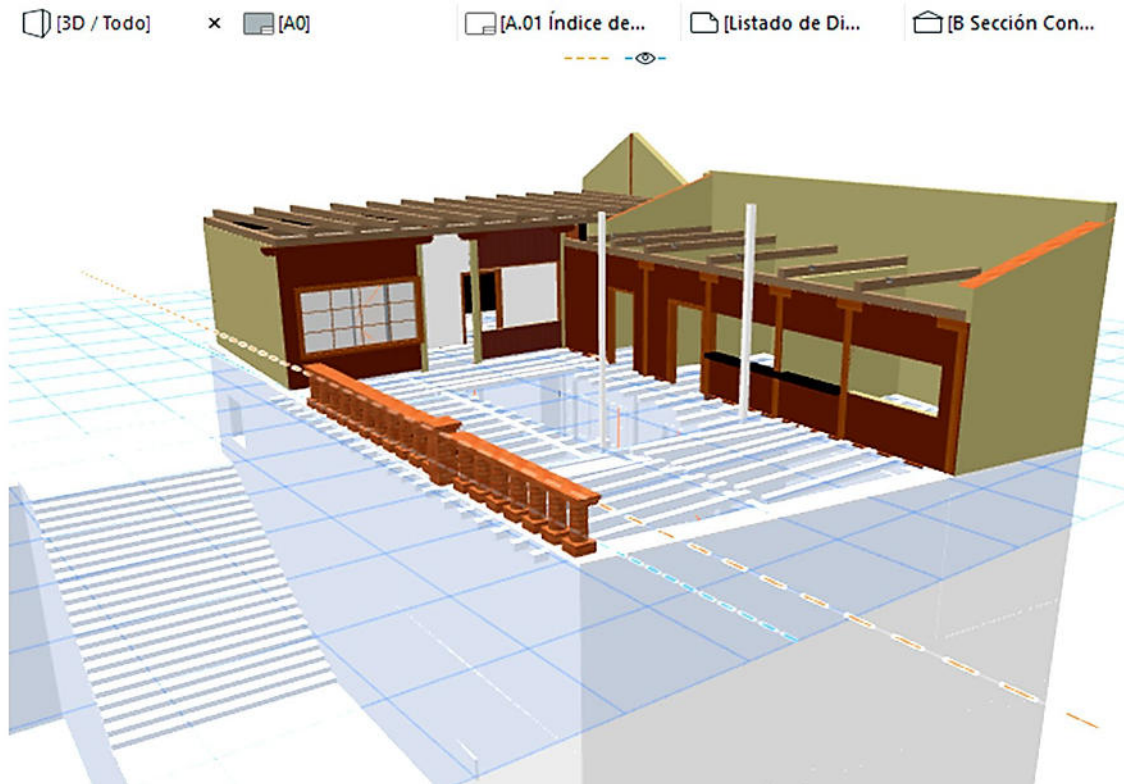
Etapa de construcción virtual planta alta
